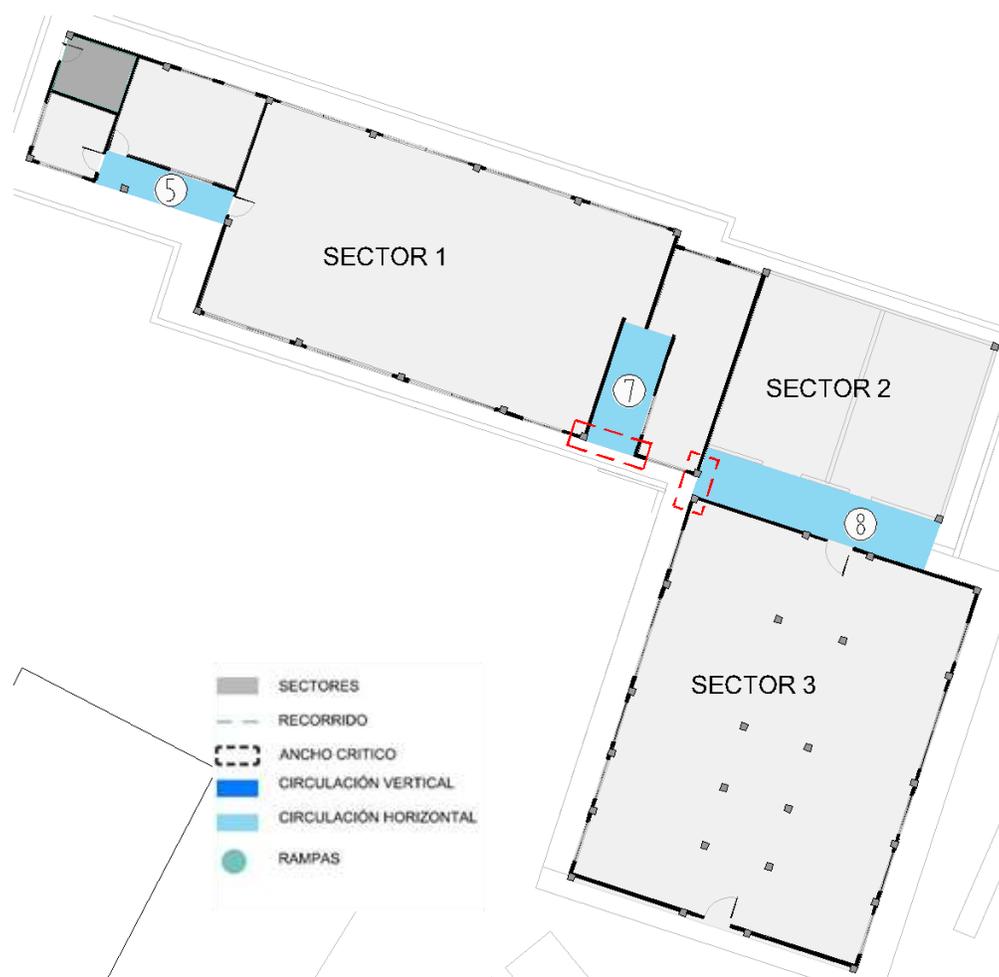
Planta esquemática de circulaciones Bloque No.30
